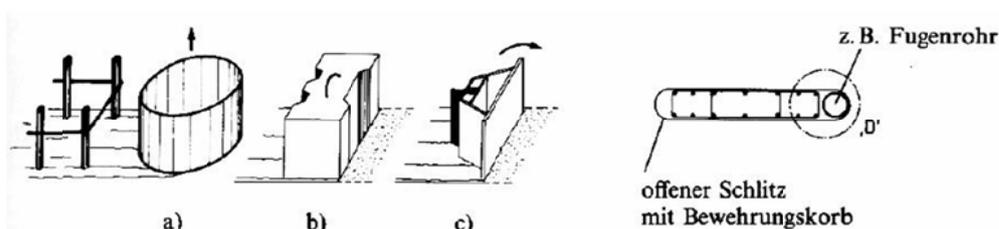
Fugensysteme zwischen den Lamellen<sup>61</sup> - a) Abstellrohr; b) Betonfertigteil; c) Fugenbandelement
